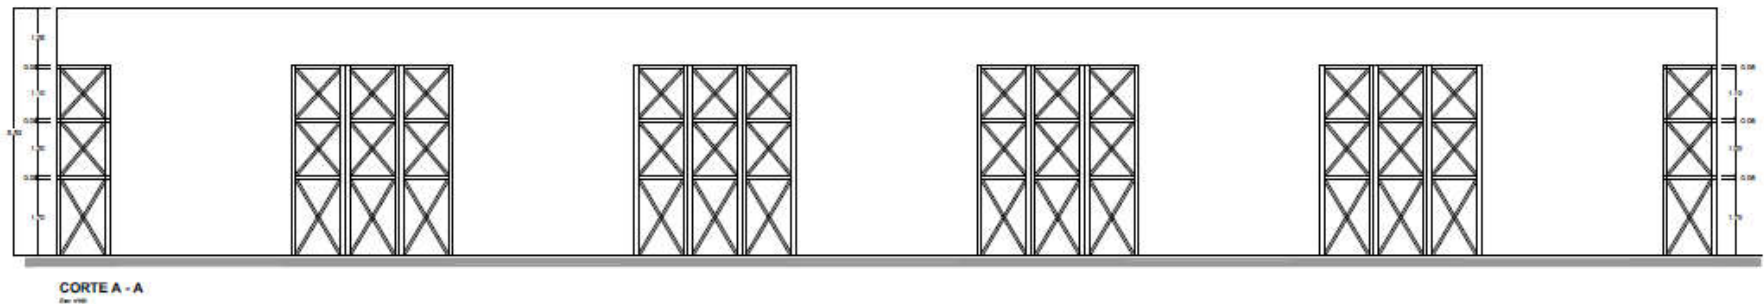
Plano – vista frontal de Estantería (Fuente: Elaboración Propia)
